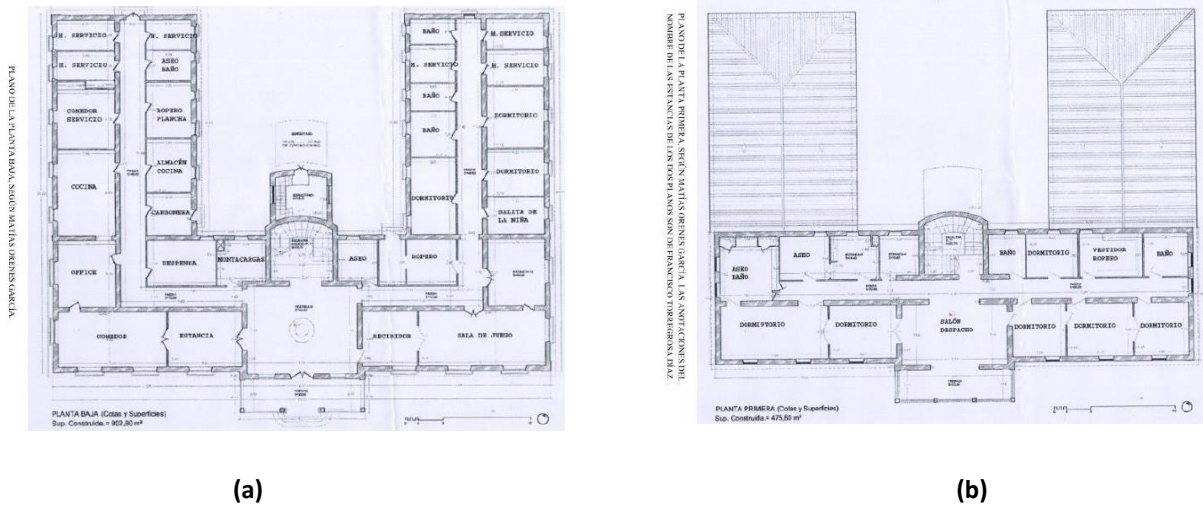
Planos originales del Palacio del Marqués de Fontalba: (a) Plano de planta baja y (b) Plano de planta alta. Fuente: Matías Orenes García, TFM 2015
